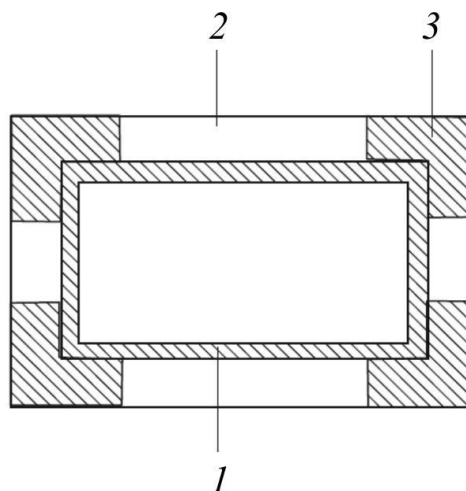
Схема утеплення фундаменту: 1- контур будівлі; 2 - утеплення по периметру будівлі; 3 - додаткове утеплення в кутових зонах фундаменту
